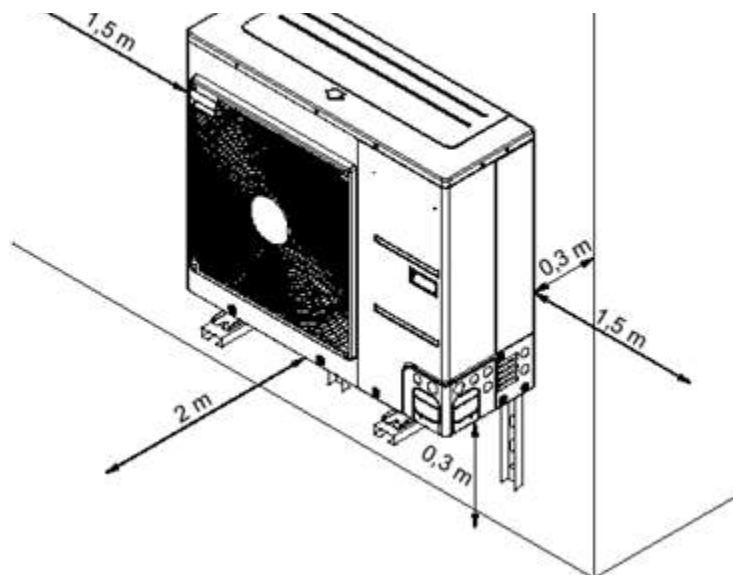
Installation du poste extérieur LAW 9IMR à l'aide d'un support mural
